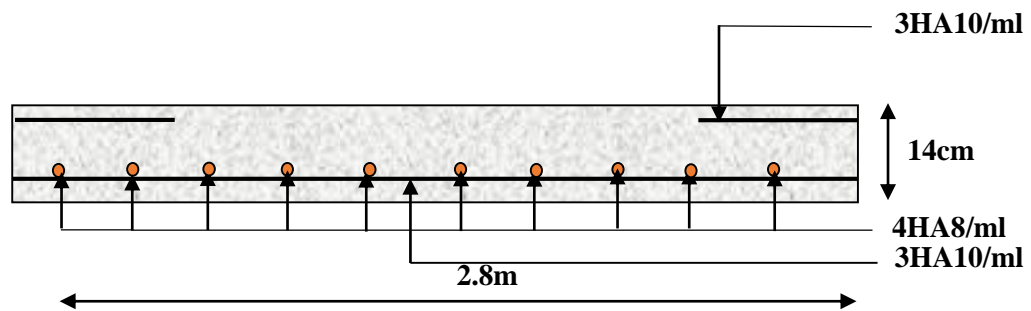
Schéma de ferrailage de la dalle pleine type N° 4.
